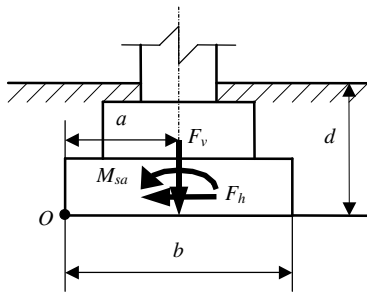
Схема до розрахунку стійкості фундаментів будівель проти перекидання
